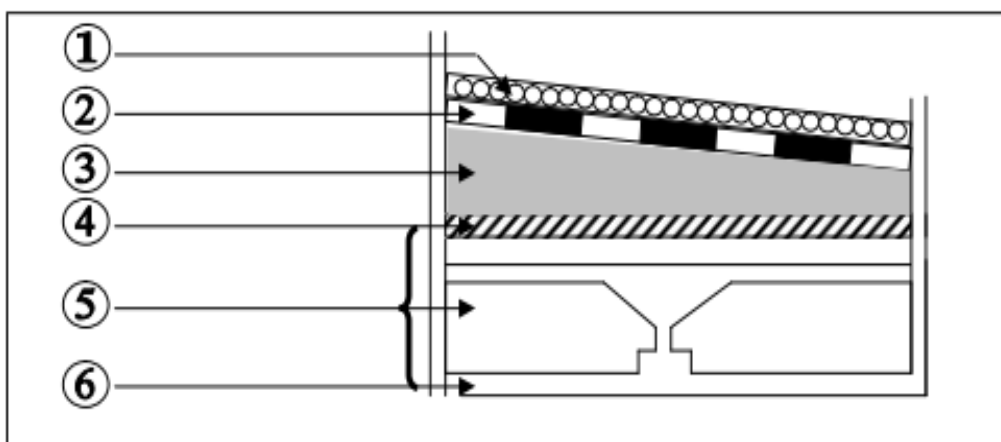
Détails d'un plancher d'une terrasse inaccessible.
